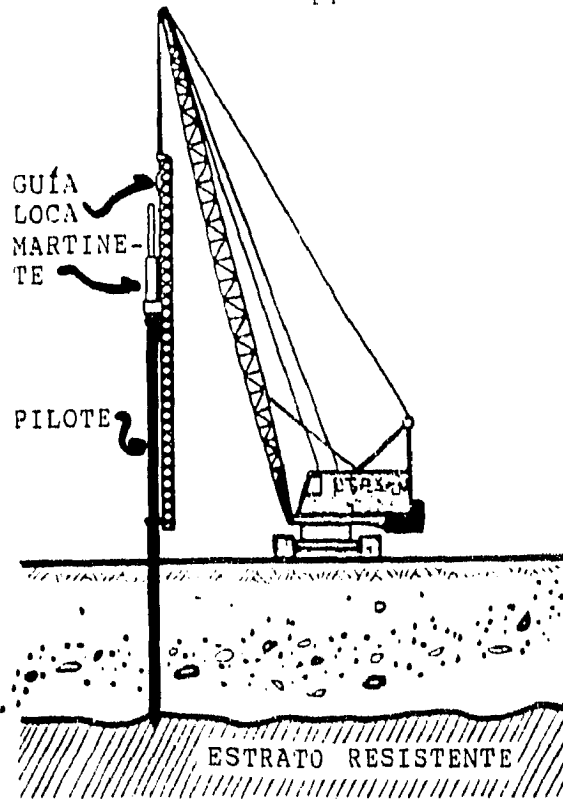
PILOTE HINCADO CON GUÍA COLGANTE.
